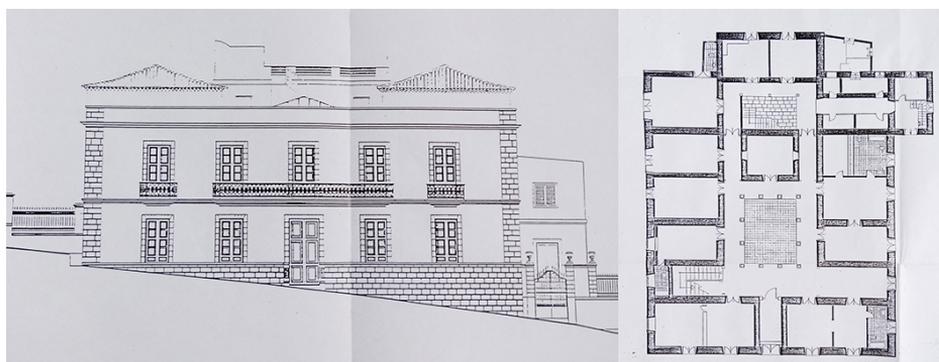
Alzado y planta de la casa Díaz Flores, c. 1860.
